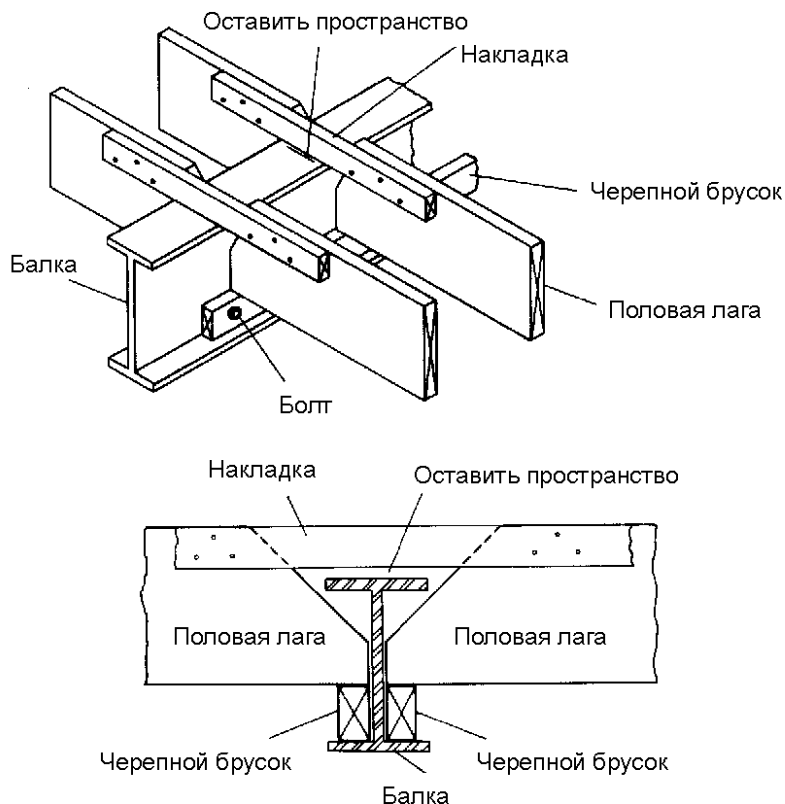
Системы для крепления половых лаг на металлических опорных балках (Forest Products Laboratory)
